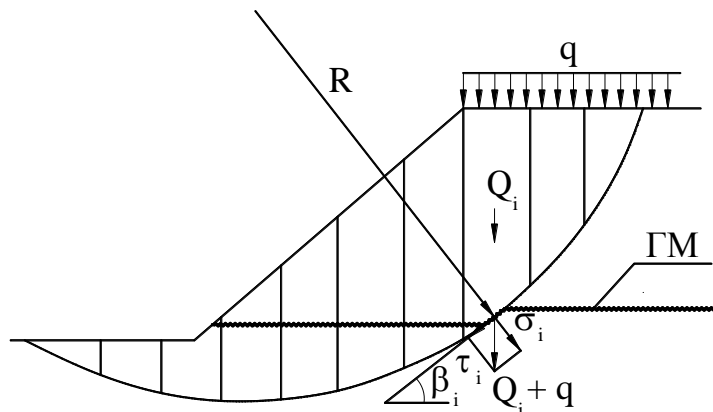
Схема к расчету насыпи на слабом основании с учетом прослойки из ГМ
